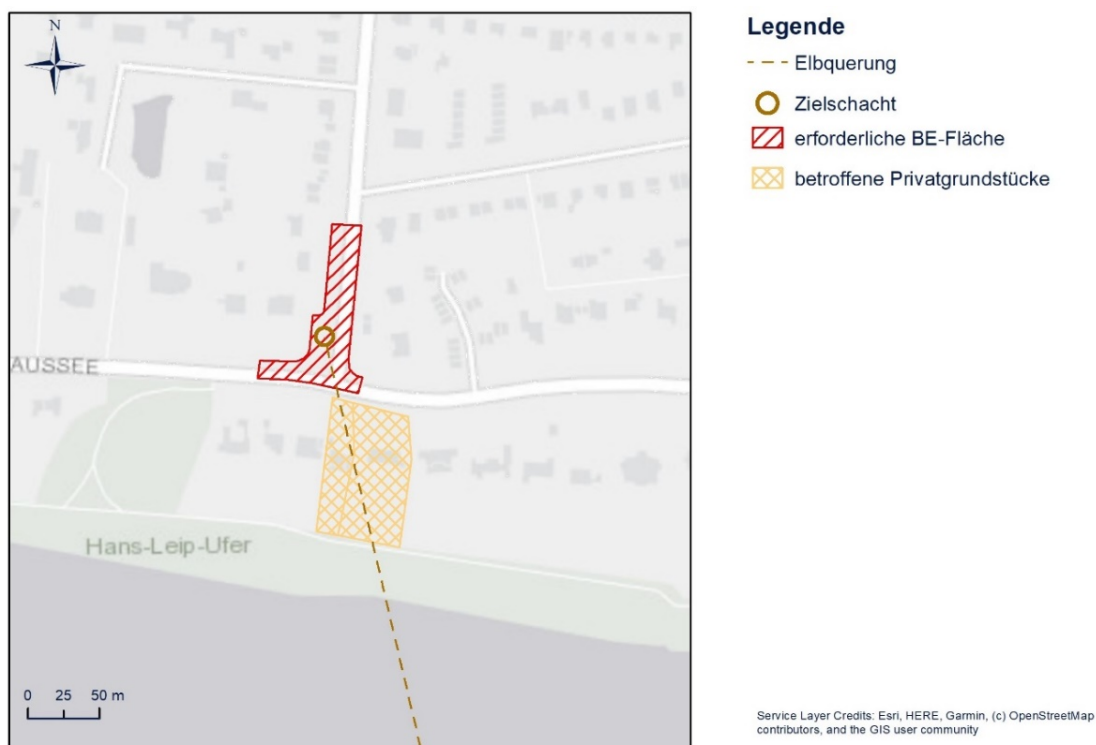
BE-Fläche und betroffene Privatgrundstücke beim Zielschacht im Kreuzungsbereich Elbchaussee / Parkstraße
